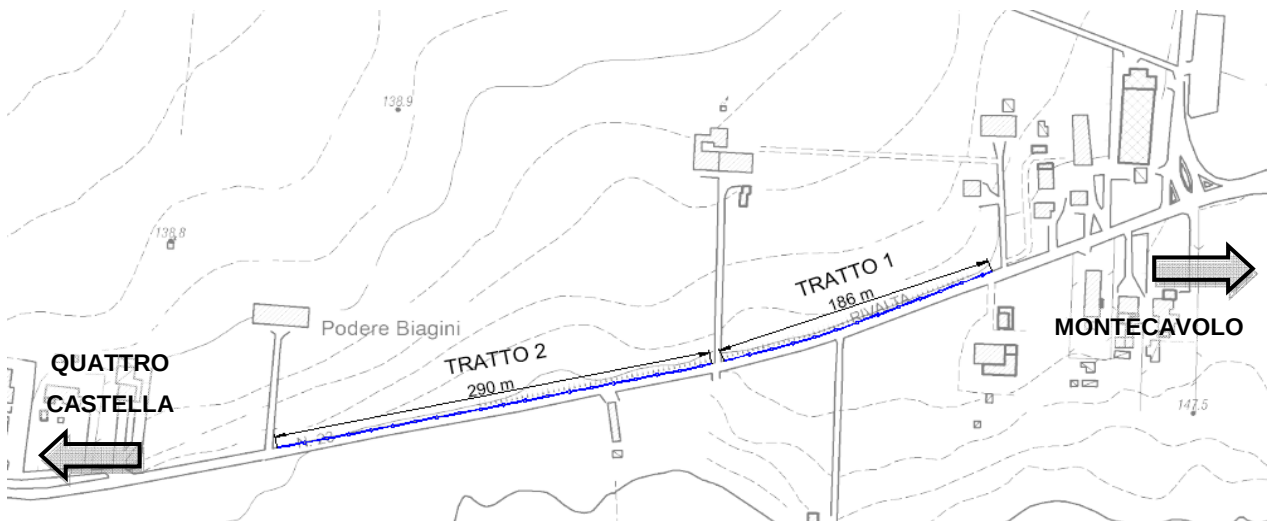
Planimetria dell'intervento di posa delle barriere bordo laterale.
